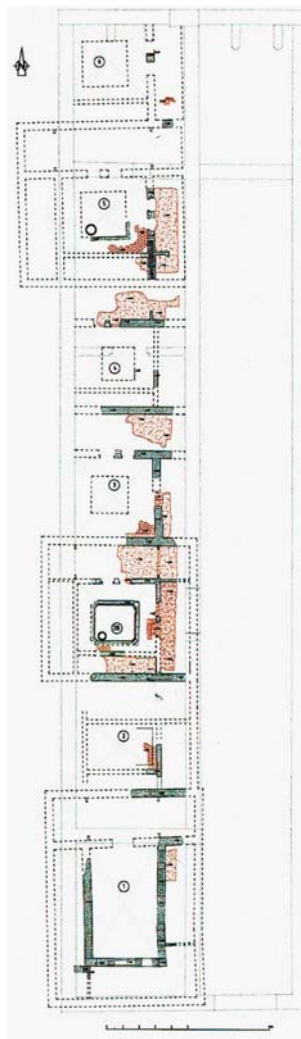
Dâr as-Sugrà*, Murcia. Planta de las casas localizadas en el frente oeste del jardín de crucero (Pozo, 1999, fig. 8).
